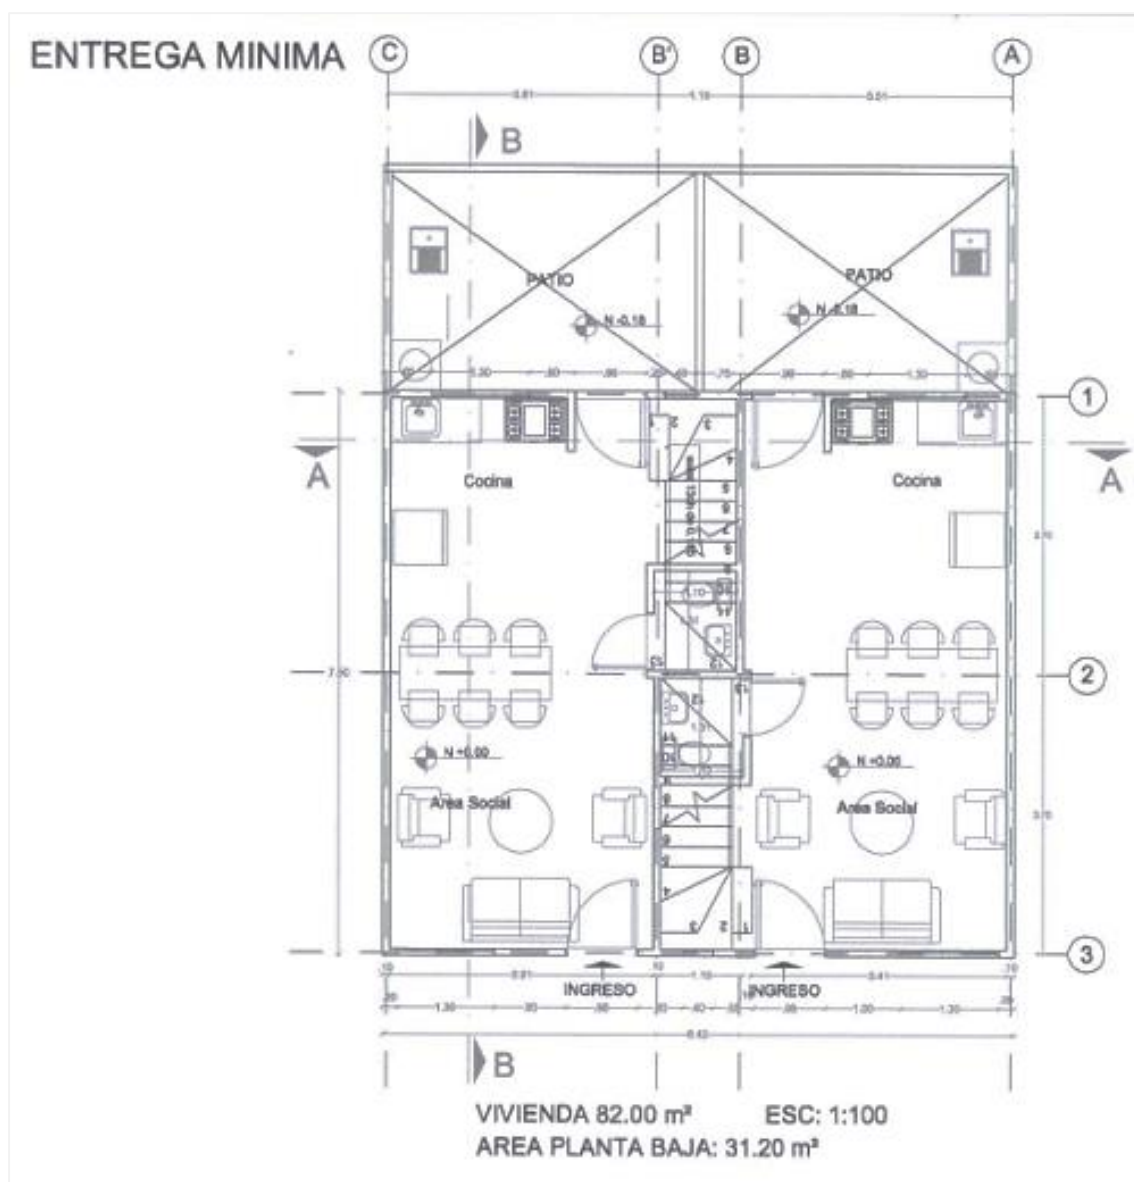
PLANTA BAJA de Vivienda Tipo C82CG
